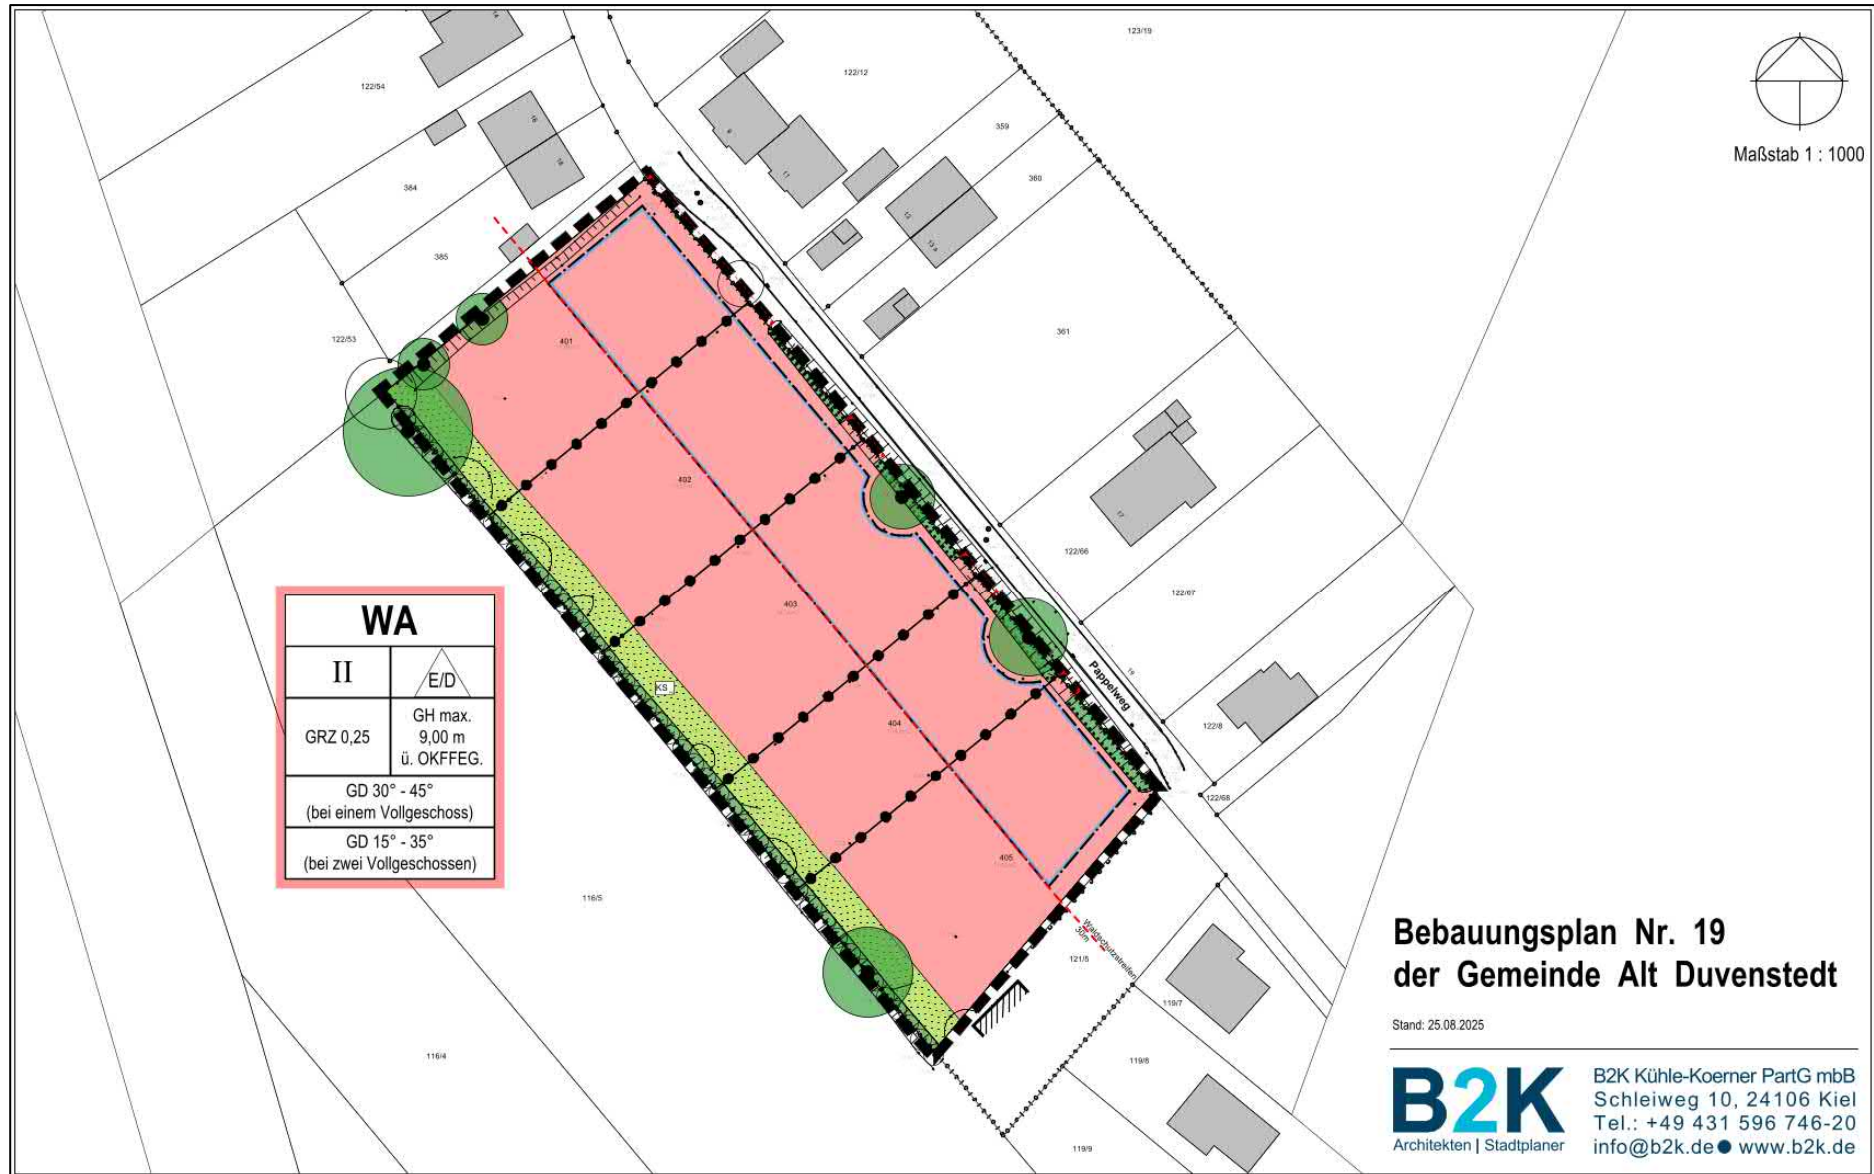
Planzeichnung für den Bebauungsplan Nr. 19 der Gemeinde Alt Duvenstedt (MATTHIESEN & SCHLEGEL, Stand: 25.08.2025)
